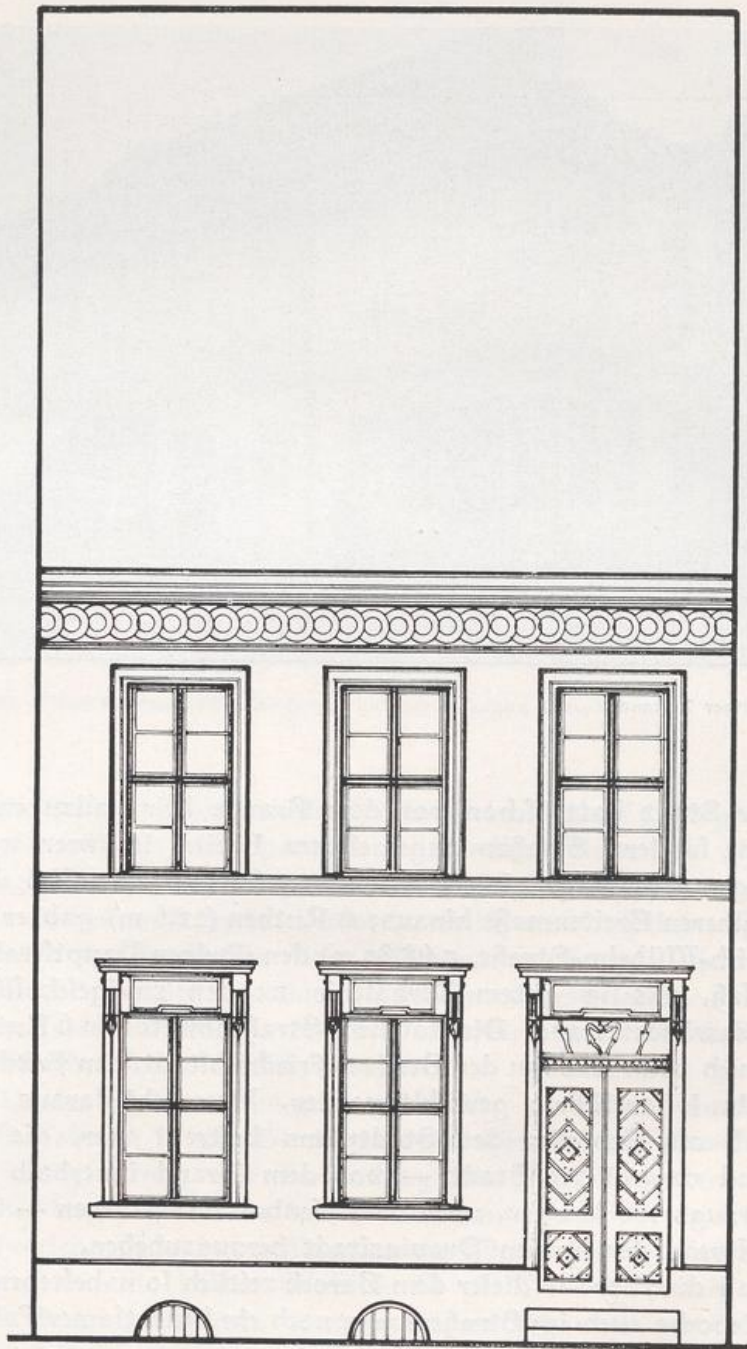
Haus Ferdinandstraße 17 nach Brauchs Entwurf
